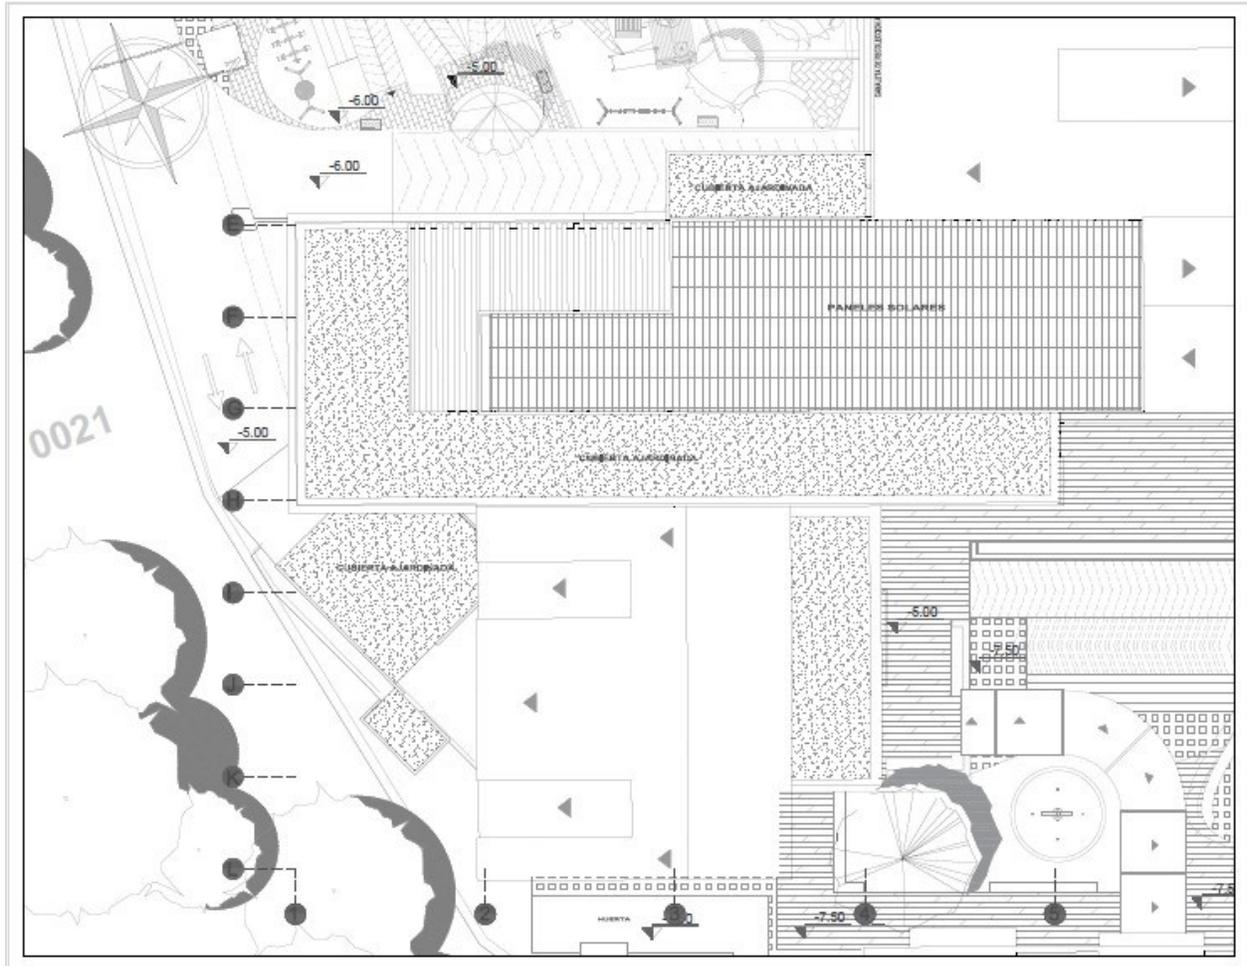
Planta Cubierta Edificación 2 (Rubiano, 2020)
